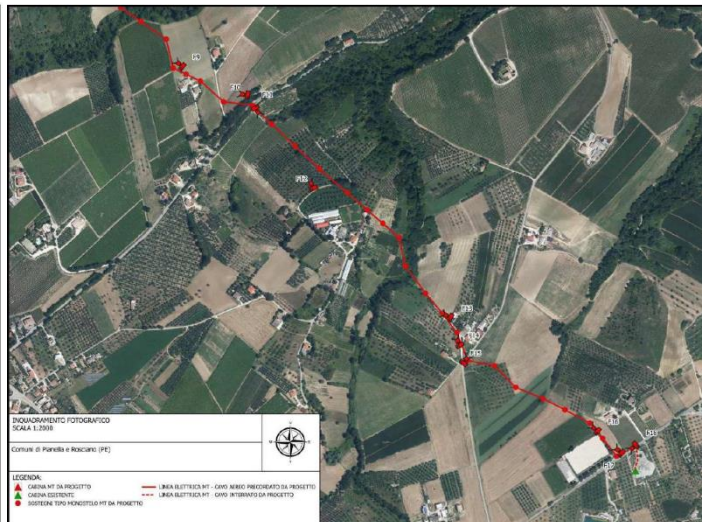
(c) – Inquadramento delle opere di rete (2° tratto) su ortofoto
